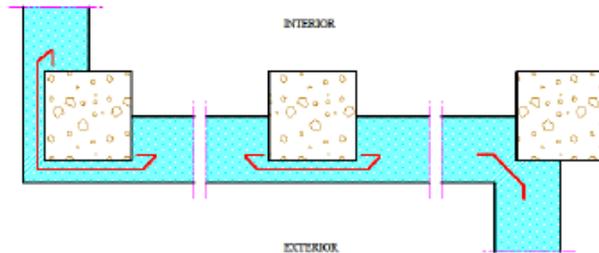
Encuentros de fachada con pilares. Fuente CTE
